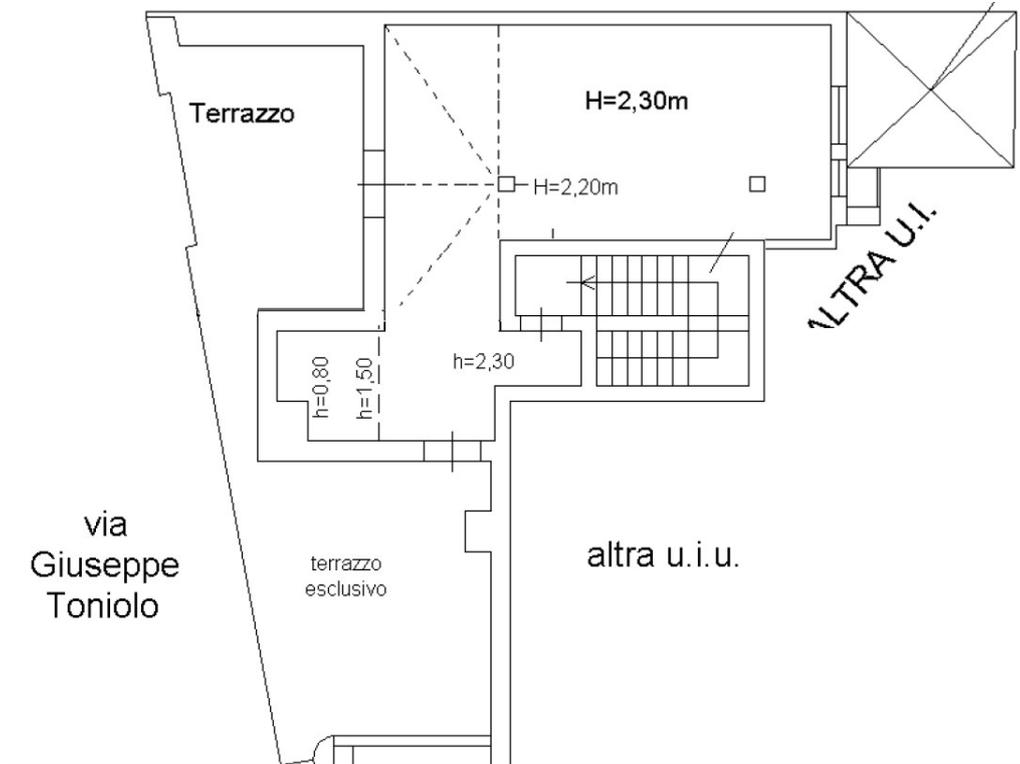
Planimetria dei locali in terzo piano con annesso terrazzo a livello.
